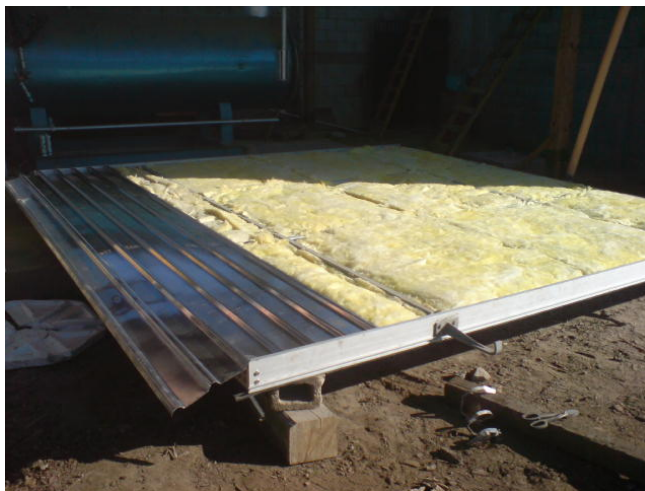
Compuerta y mecanismo de apertura y cierre instalados
